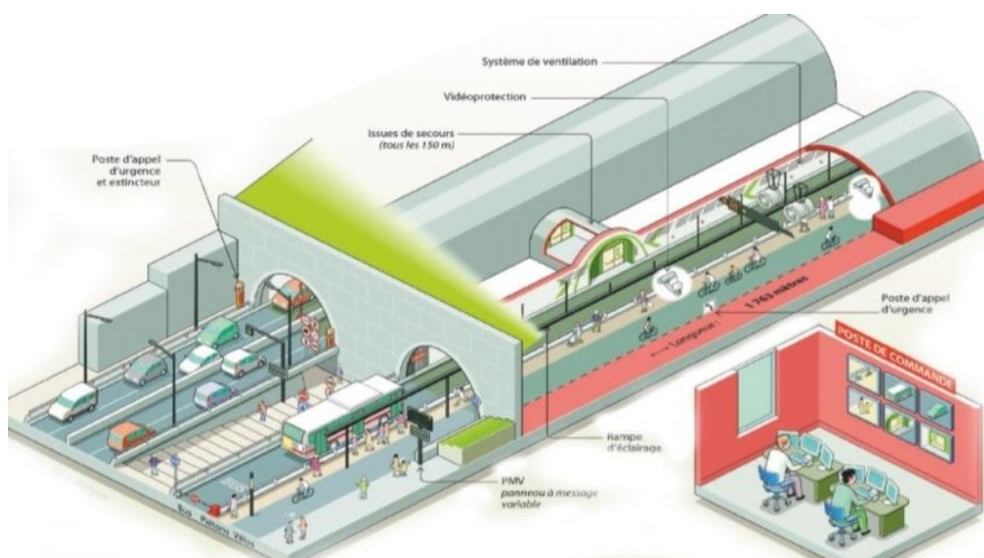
Deux tubes du tunnel de la Croix-Rousse [Grand-Lyon, 2013]
